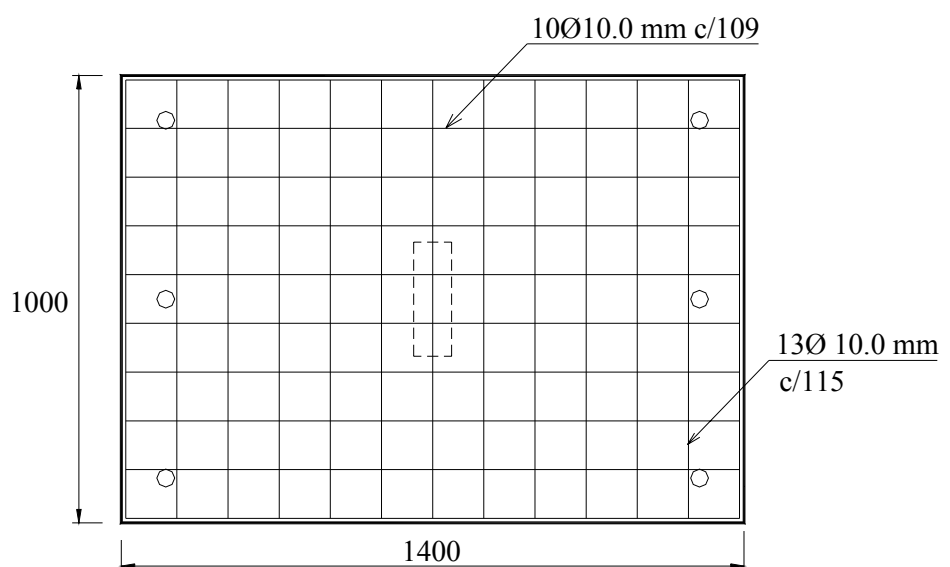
Armadura das lajes L1a, L3a e L5a de Vilhena *et al.* (2006)
